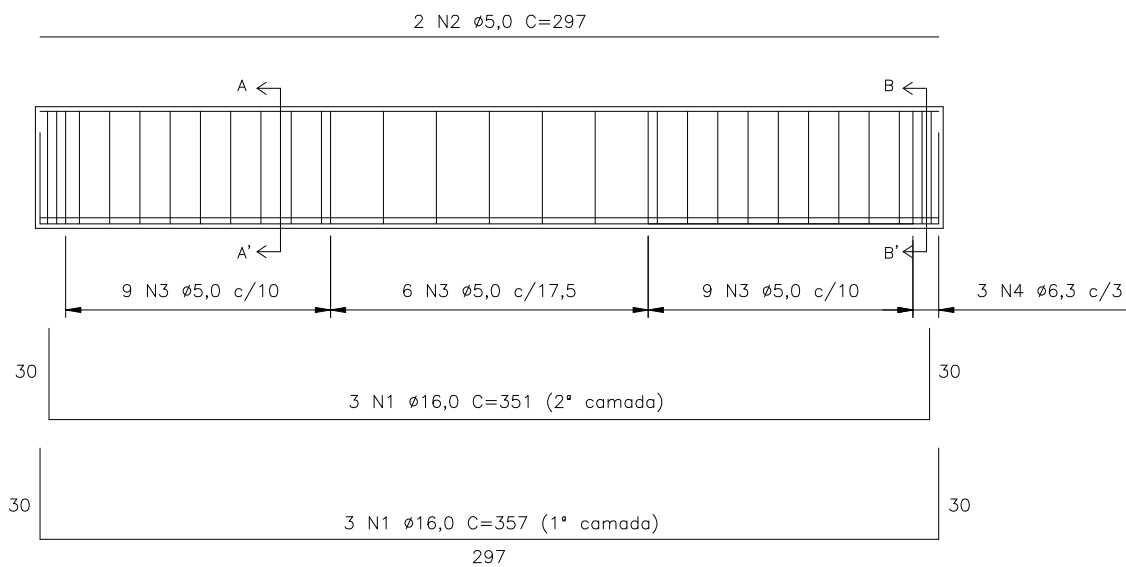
Armadura longitudinal das vigas da Série I.
